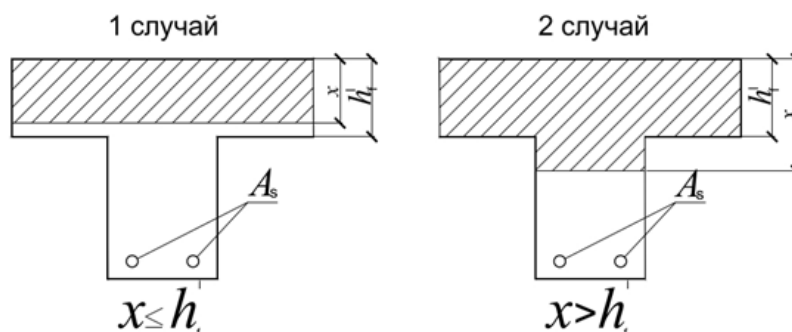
К расчету площади сечения растянутой продольной арматуры в изгибаемом элементе таврового сечения.
